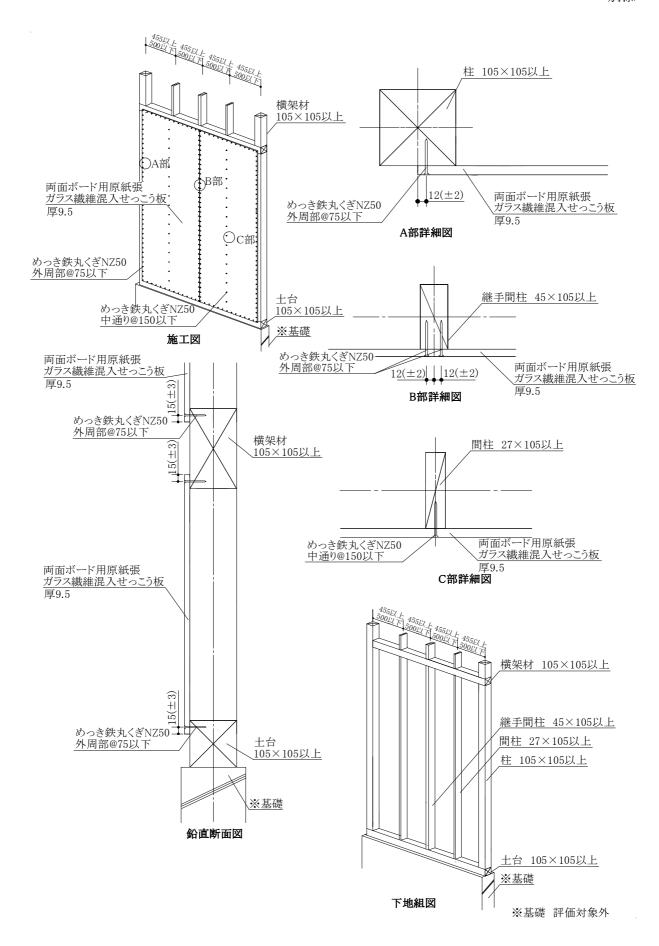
施工詳細図:1枚張りの場合 (寸法単位:mm)
